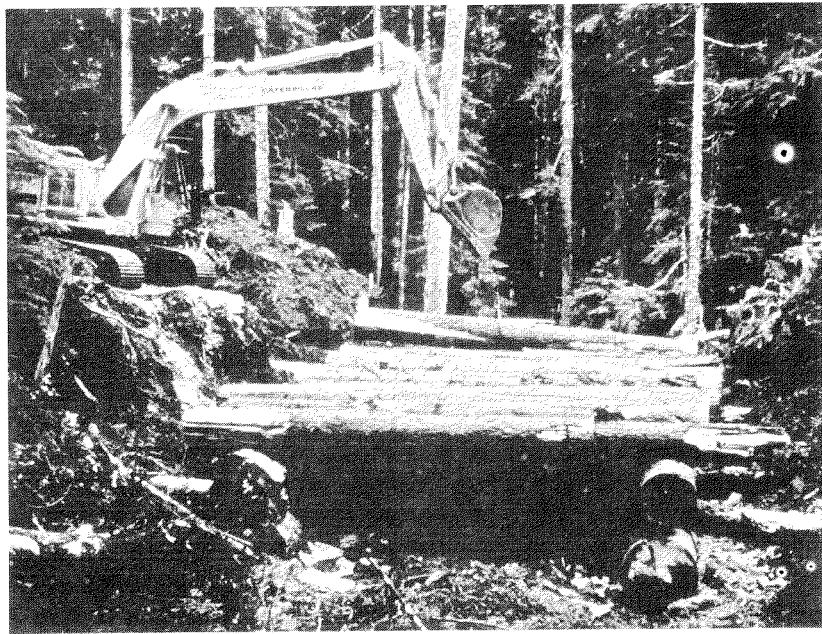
Installation de ponceaux à l'aide d'une pelle hydraulique.
